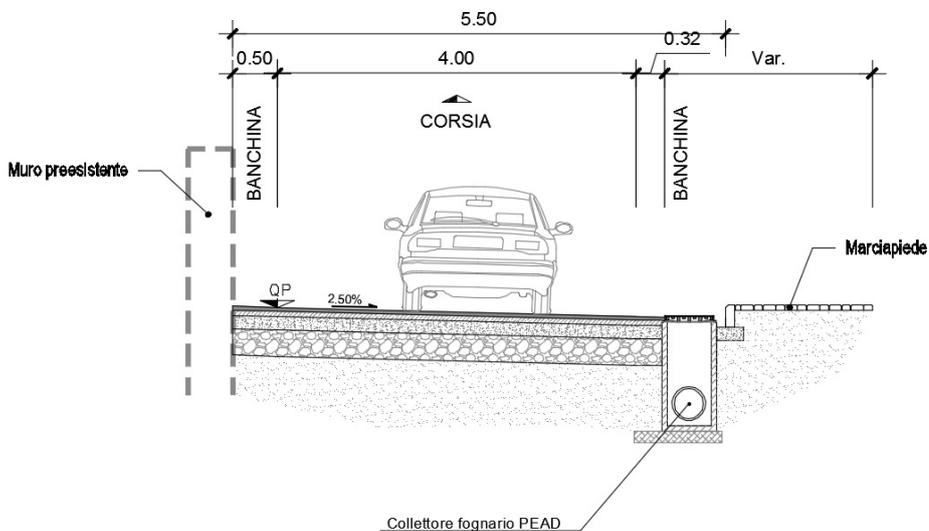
Sezione rampa di accesso a nuova viabilità (affiancamento muro preesistente)
